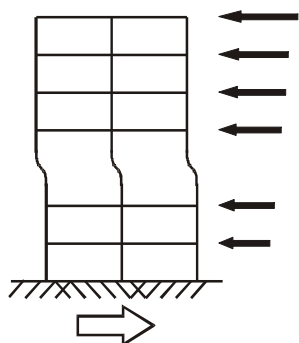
Bâtiment avec un niveau de plus grande hauteur que les autres niveaux. Sans précaution, la flexibilité du niveau de plus grande hauteur peut entraîner la ruine de l'étage (soft floor). (AFPS, 2002)
